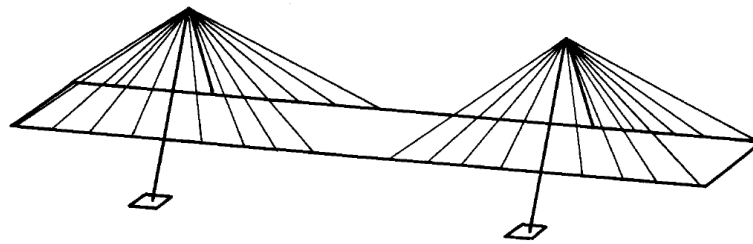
Arreglo espacial de cables con 2 planos verticales (Troitsky, 1988)
